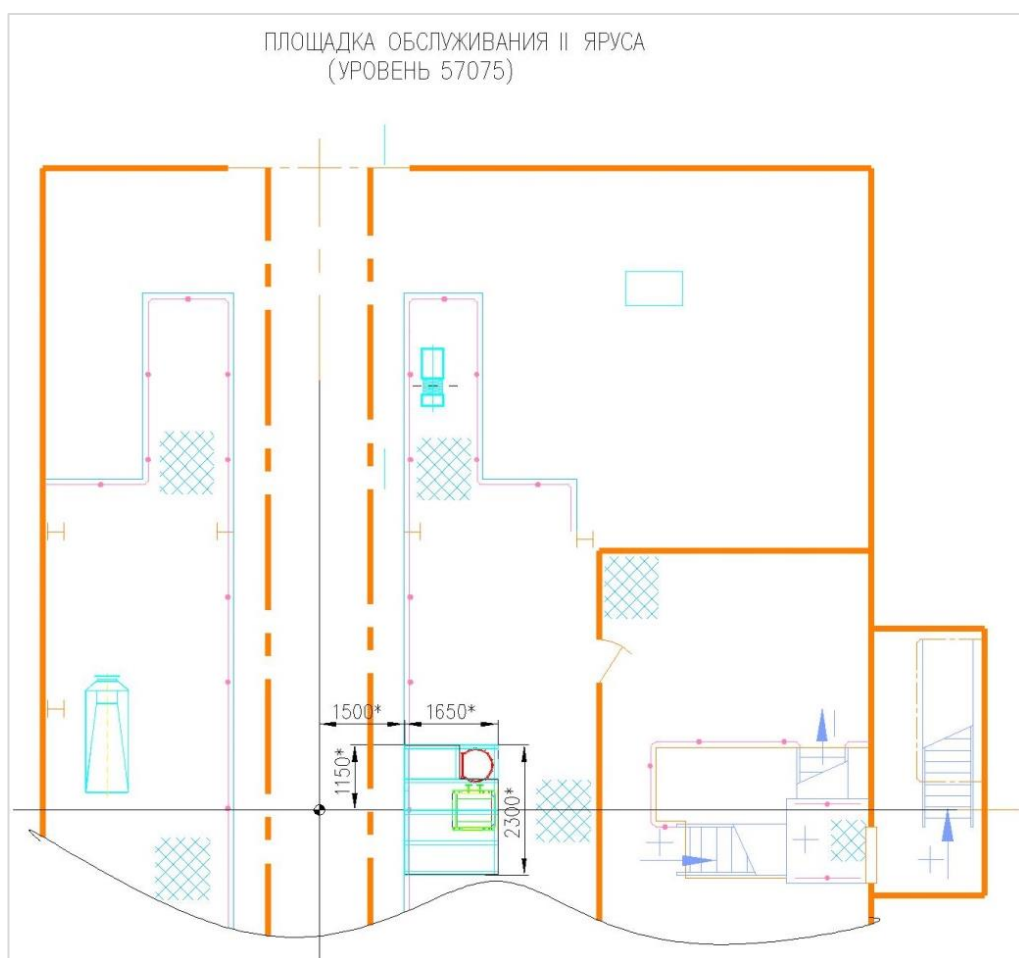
Площадка нагревателя HLN84073A над площадкой обслуживания II яруса
